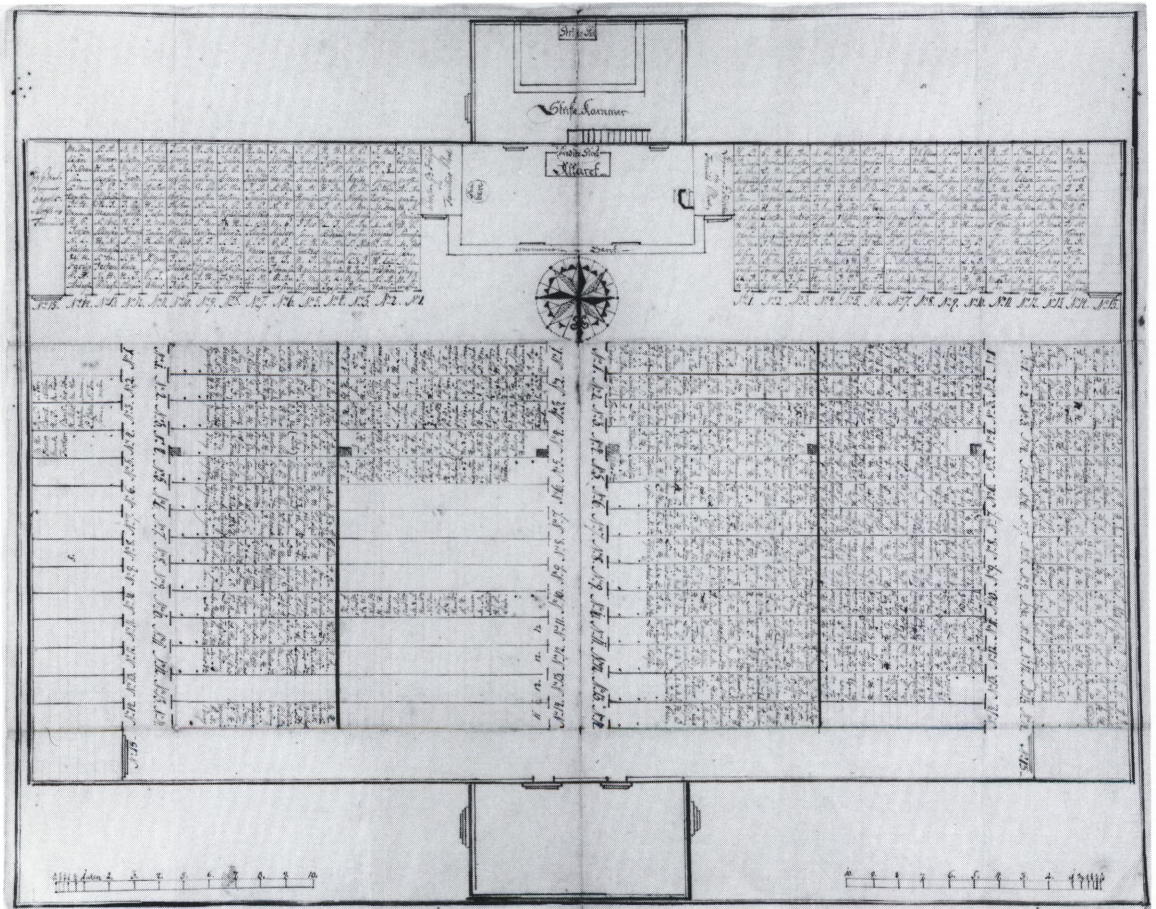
Grundplan af kirken med stoleindretning og fordeling af sæderne 1786 (s. 2130). Syd opad. Tegning i kirkens arkiv. – *Grundriss von Kirche mit Einrichtung des Gestühls und Verteilung der Sitze 1786. Süden nach oben.
